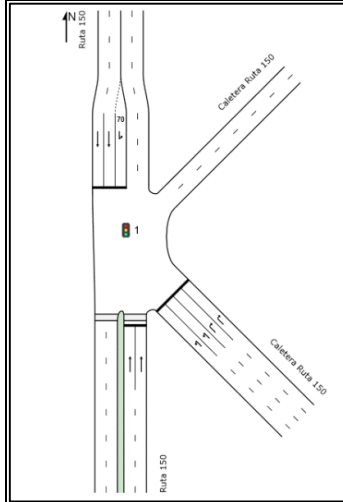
Layout Modelación Situación Actual intersección Outlet. Fuente: Sidra Intersection
